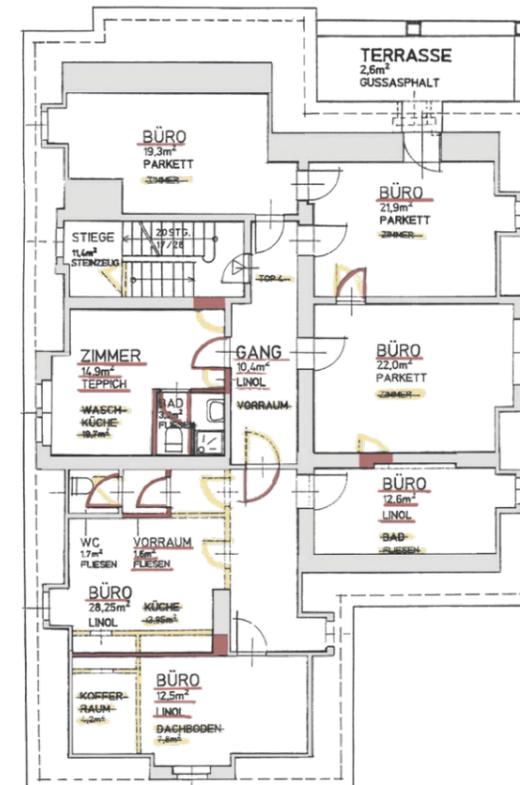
Grundriss Dachgeschoss 1994.
